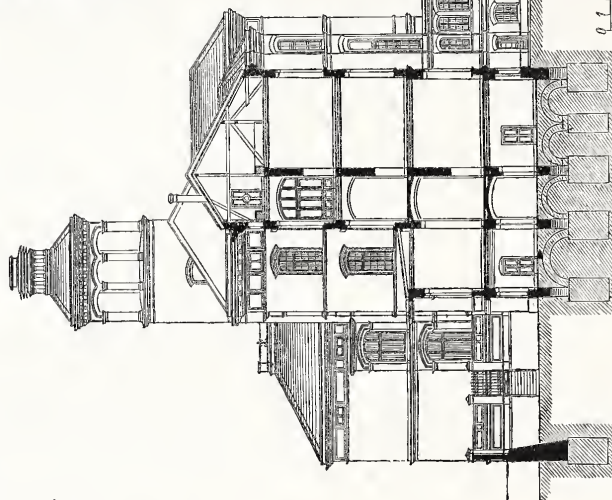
Querschnitt nach der Linie a-b-c des Gesamt-Grundrisses.
